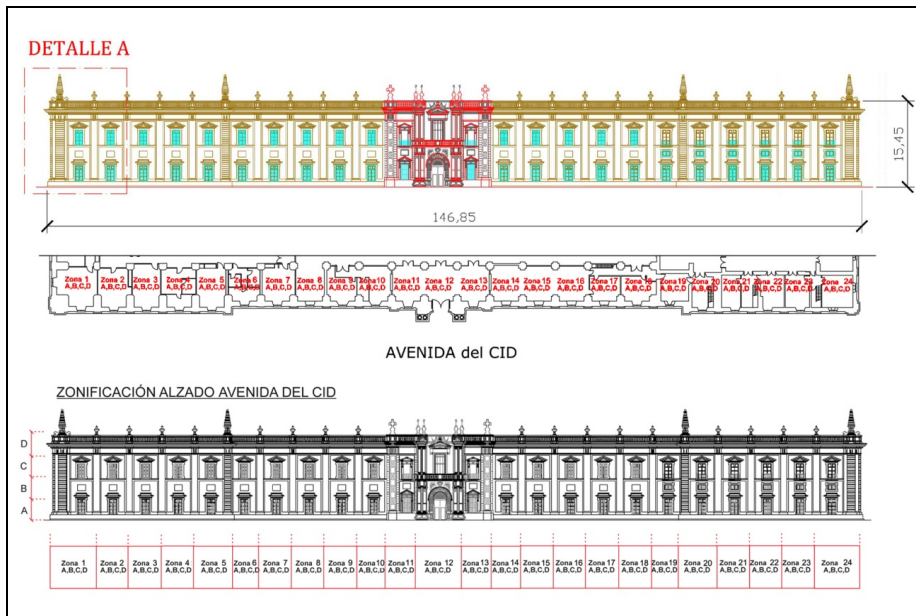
Alzado, Planta baja y zonificación Fachada Avenida de EL CID
